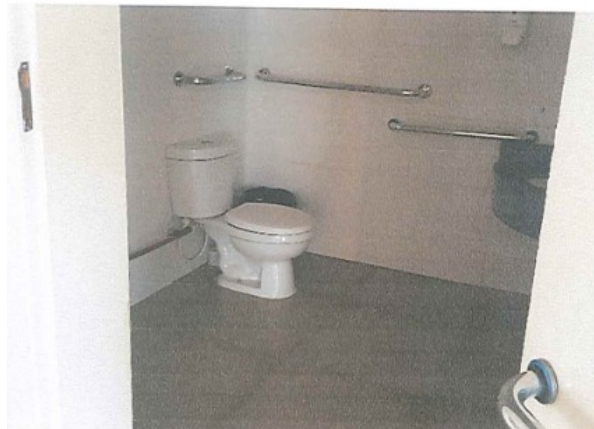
SANITÁRIO ACESSÍVEL INFANTIL
